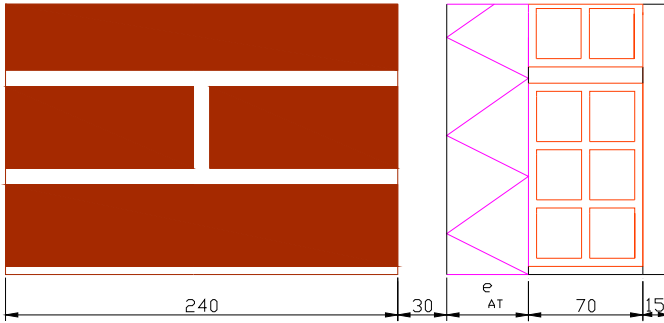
Fachada de ladrillo cara vista y monocapa. La Flota. Murcia
